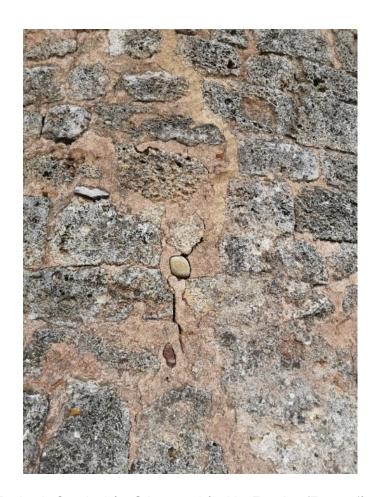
Ermita de San Andrés. Grieta en el ábside. Exterior. (Fotografía de la autora)
